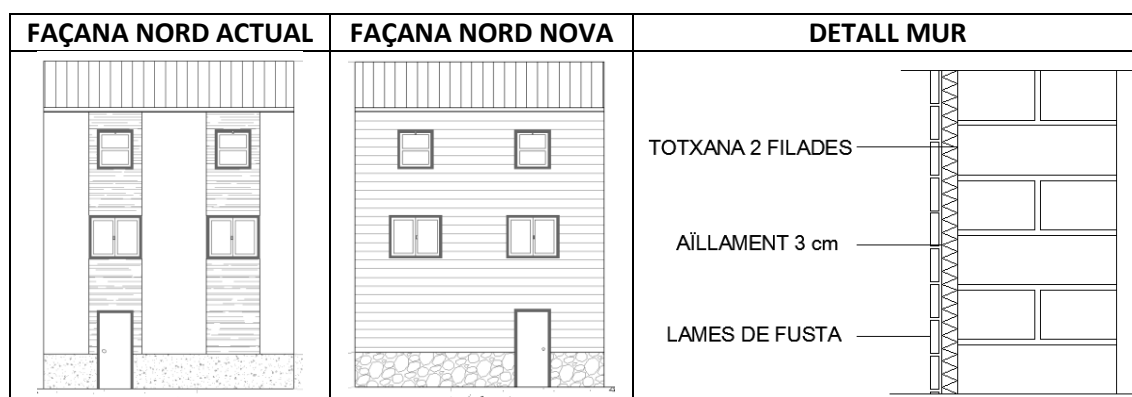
Façana nord actual, proposta i detall de la nova proposta
